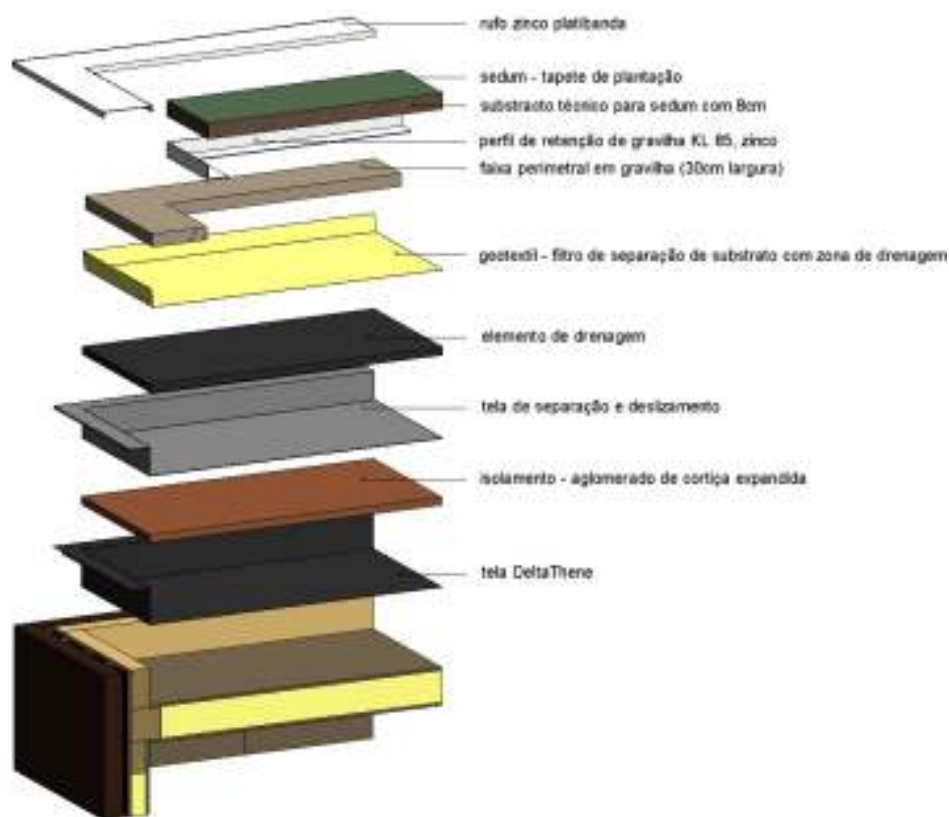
Esquema construtivo da cobertura do módulo tipo.
